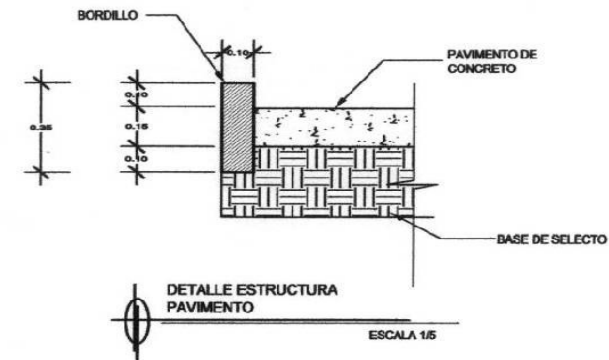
Plano de detalles estructurales del pavimento segunda fase
